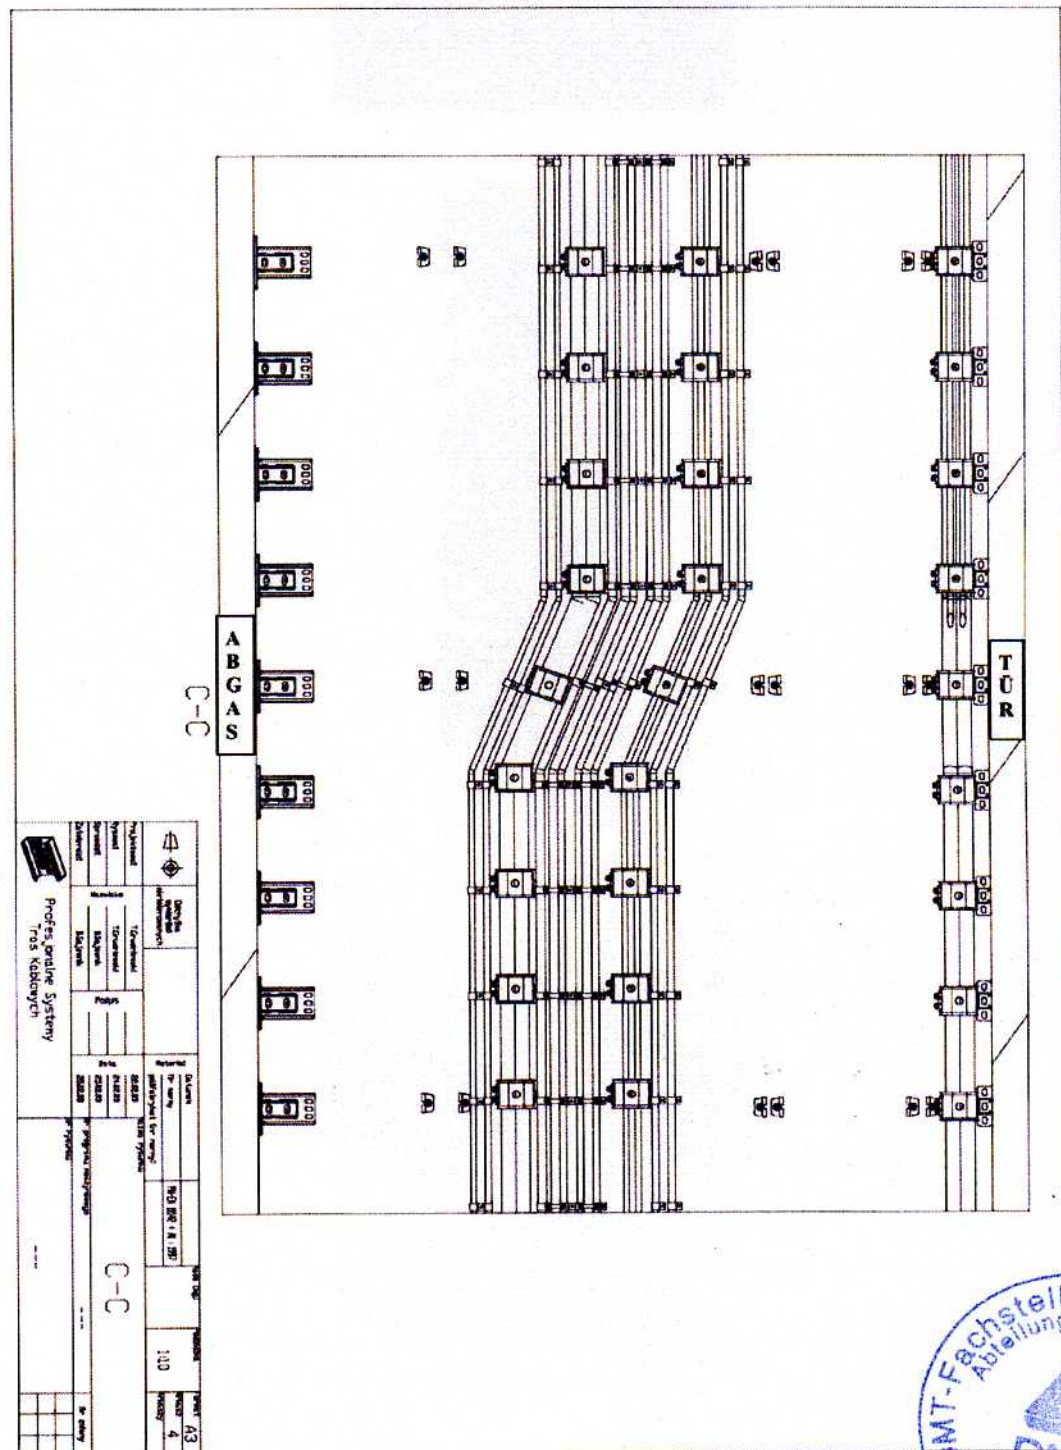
Grundriss der montierten Tragsysteme
